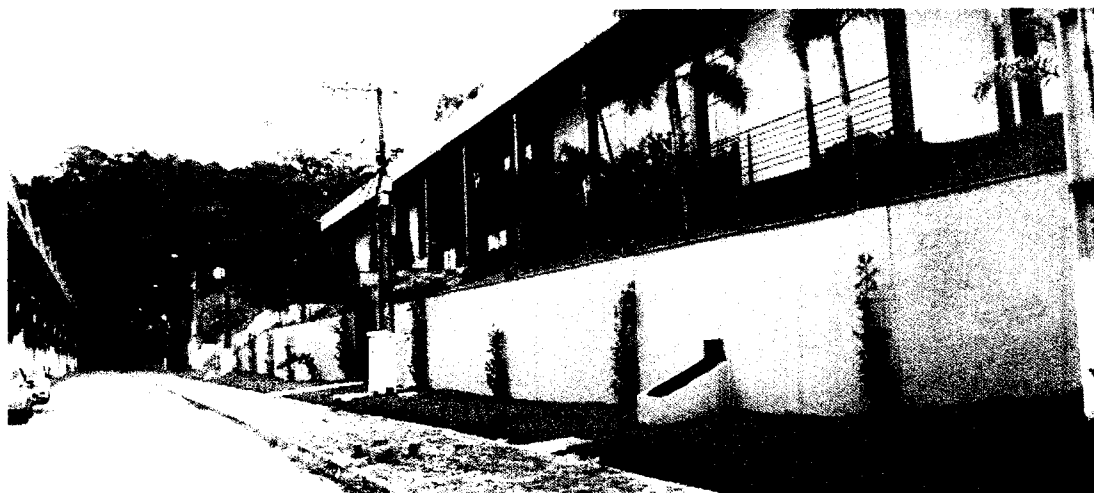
IMAGEM TESTADA DO TERRENO - RUA JOÃO BATISTA FLORES
